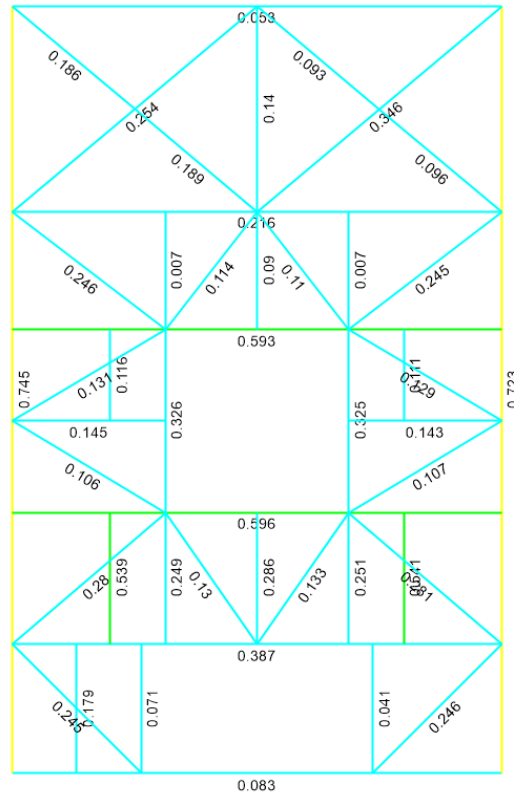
Factores de utilización planta sexto nivel para cargas de diseño LRFD.
